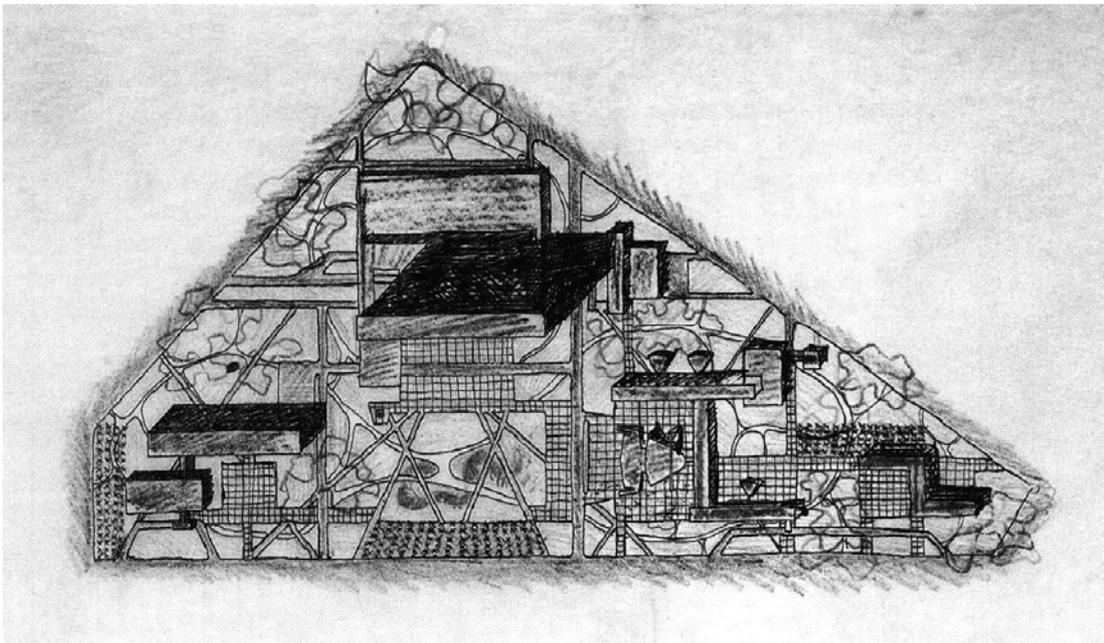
estudo da planta de situação do Centro Médico – [1948?]
